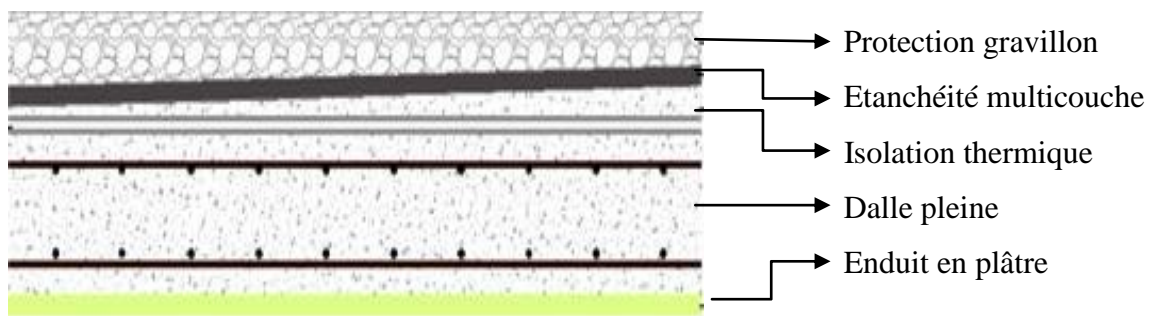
Composant s'un plancher terrasse en dalle pleine
